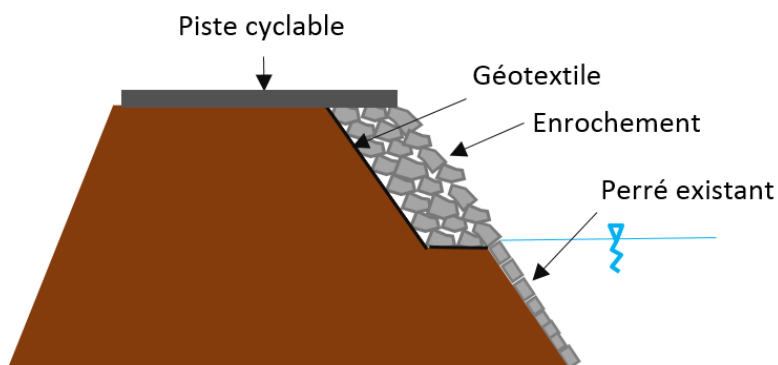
Schéma type d'un enrochement libre sur berge avec perré existant
